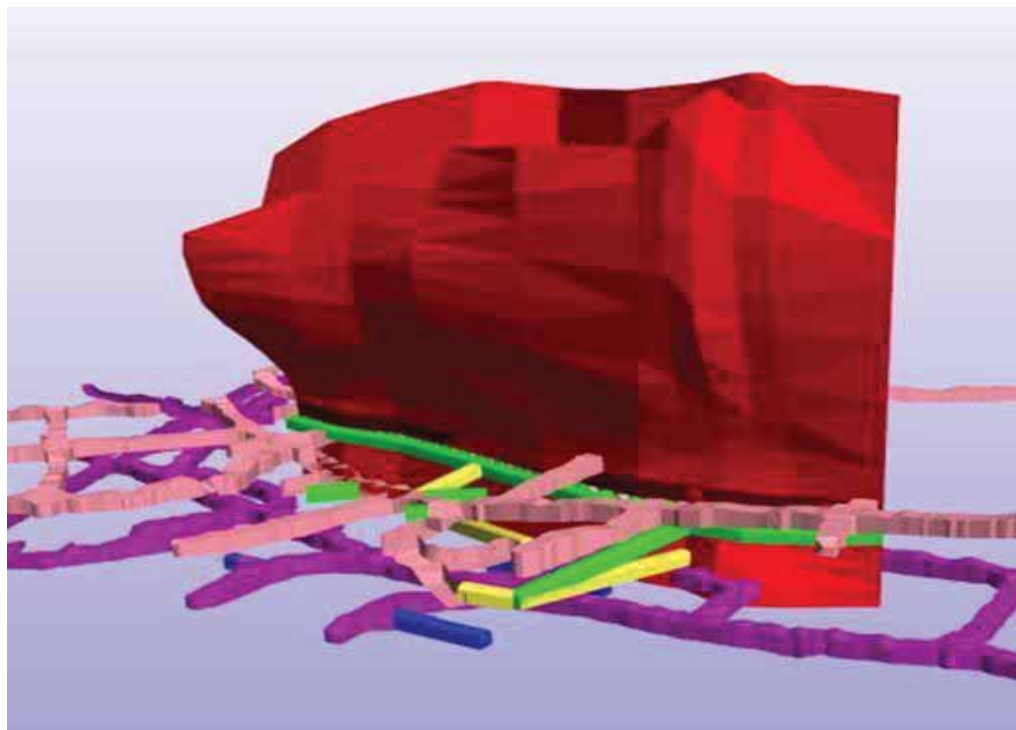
Rampa (-) para el minado de la primera fase (vista en perspectiva). Fuente: Archivo del área de Ingeniería, planeamiento y proyectos - PASHSA.
